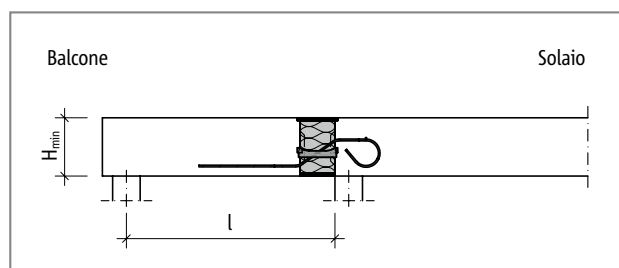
Schöck Isokorb® XT tipo QL: schema statico (XT tipo QL-V1 – V4)
